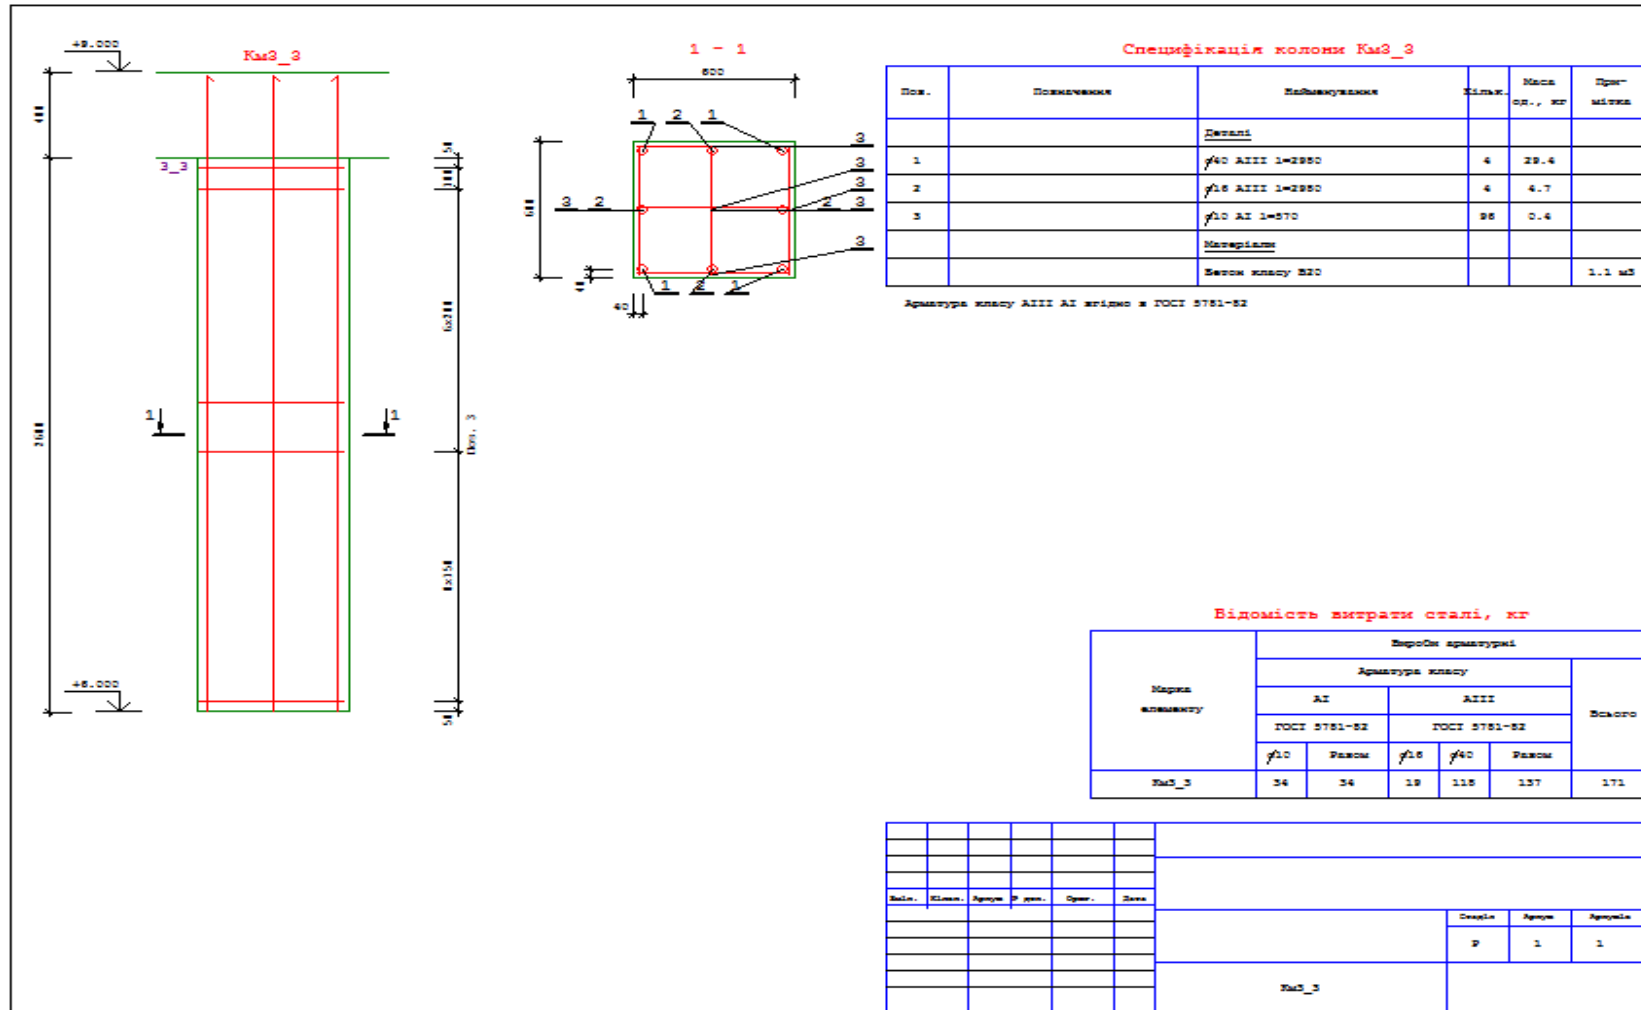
Варіант будинку з балочно - плитним перекриттям. Колона КЗ-3. Креслення робочого проекту
